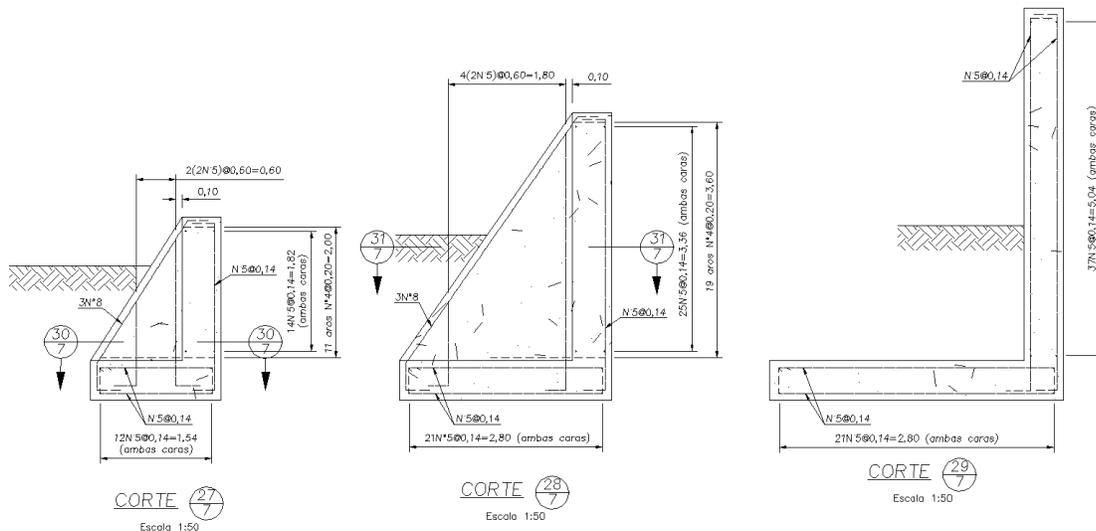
Cortes estructurales del Aletón derecho. Extraído de planos
